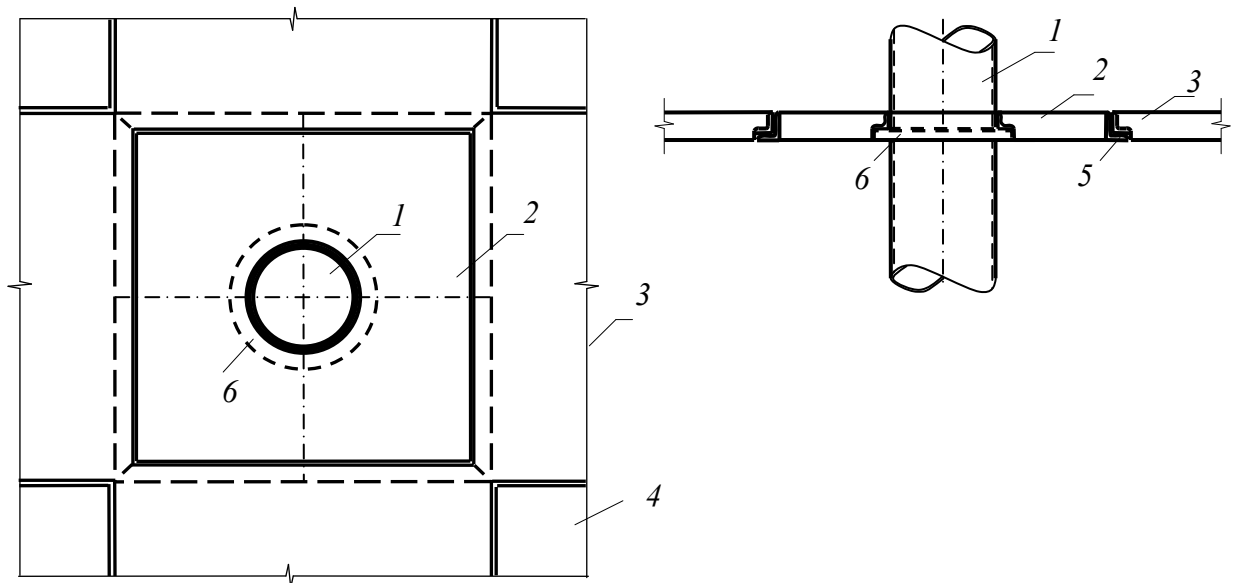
Фрагмент збірного сталезалізобетонного безбалкового перекриття:
